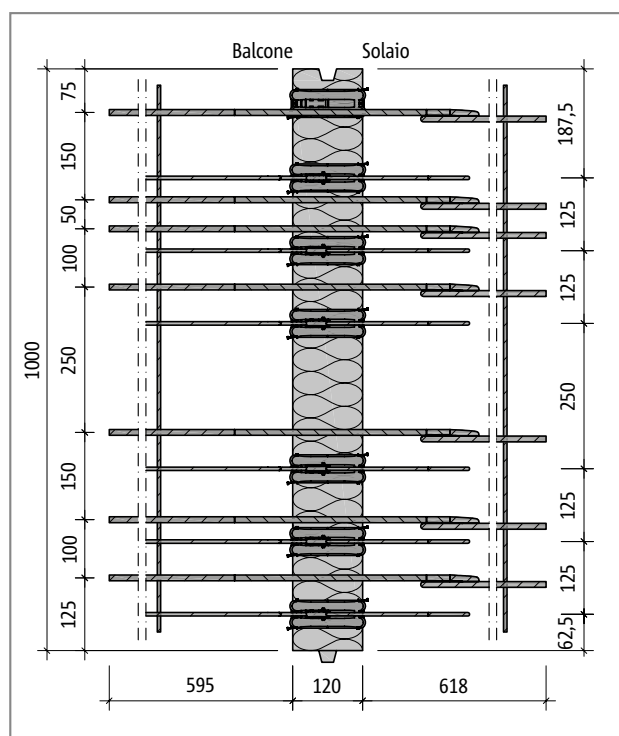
Schöck Isokorb® tipo KXT30-HV: pianta del prodotto
